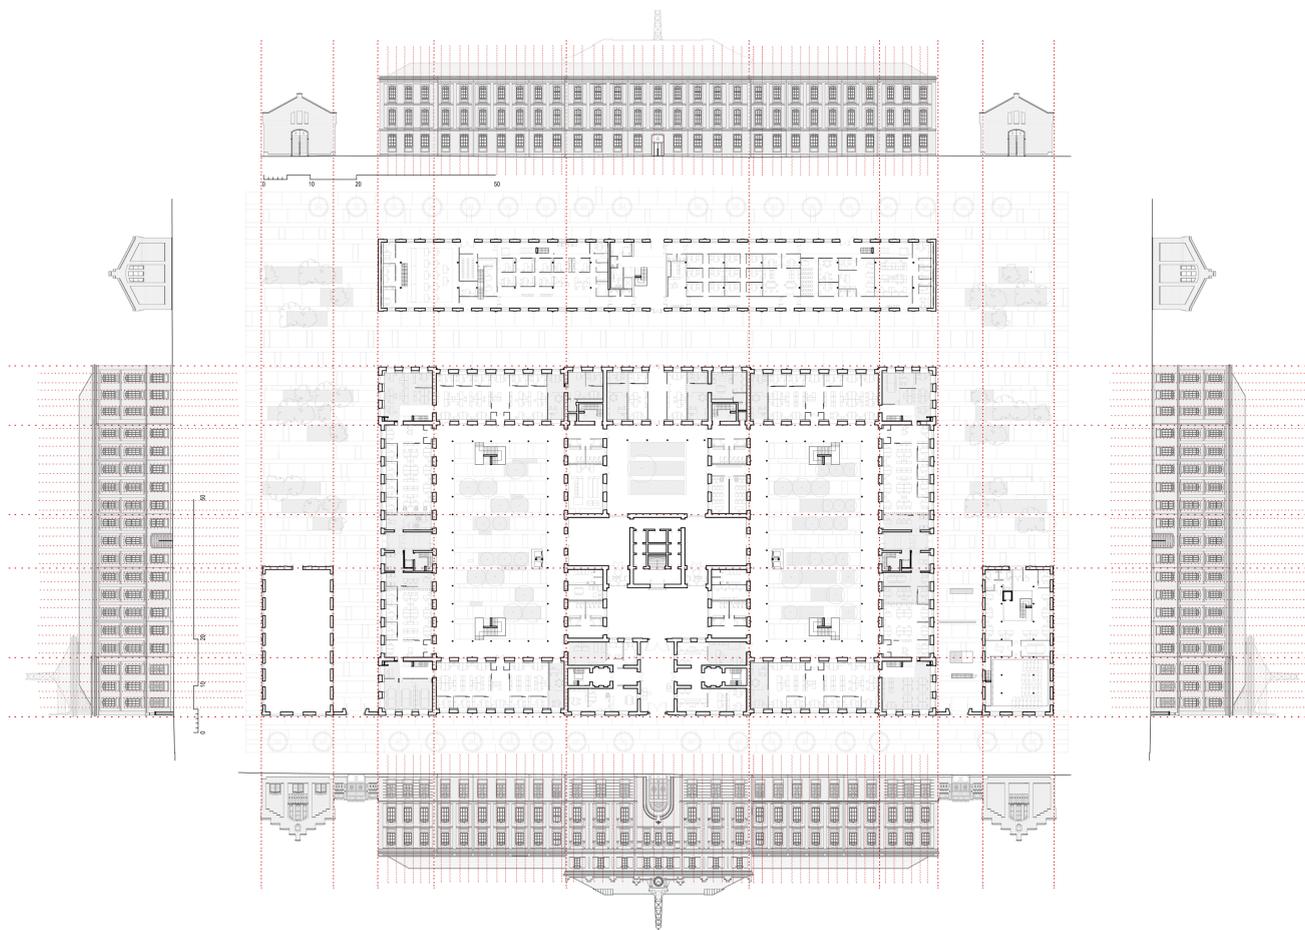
| Planta baja general y alzados de las fachadas con el análisis compositivo de ellos.
